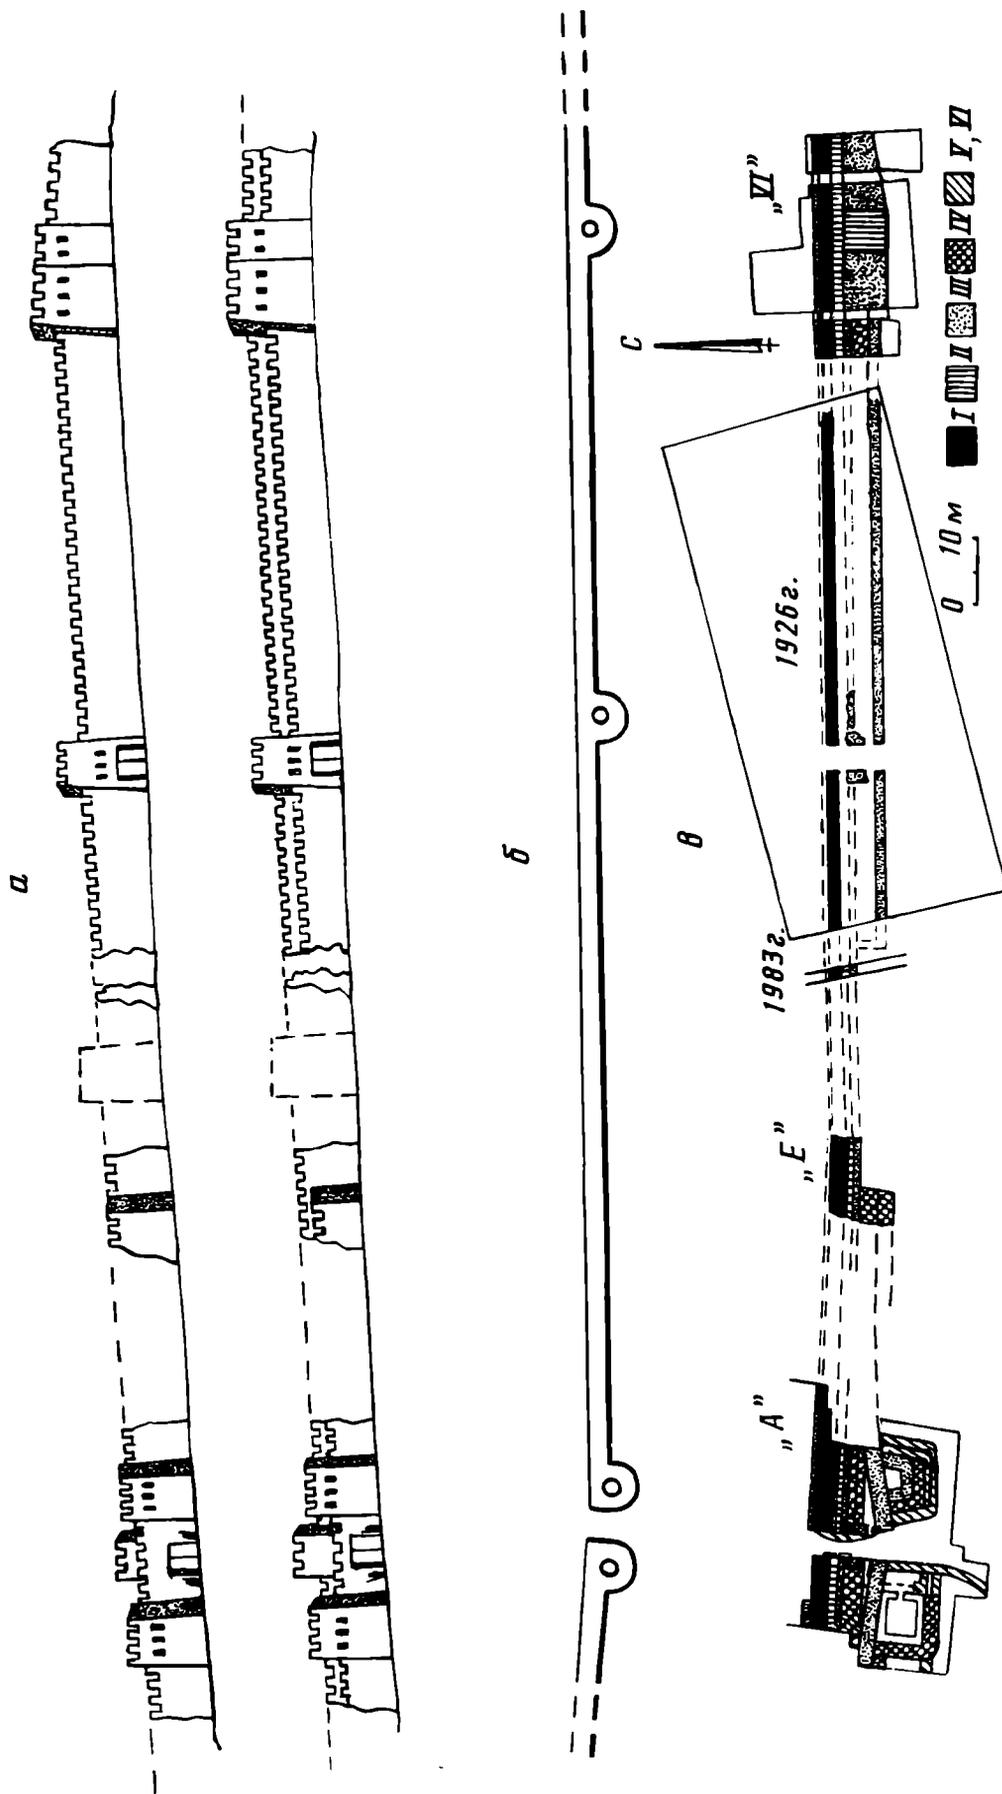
Реконструкция стены. а — объемная реконструкция южной стены четвертого строительного периода к востоку от главных ворот; б — план стены к востоку от главных ворот, по Ф. Дюбуа де Монпере; в — сводный план раскопов (I—VI — строительные периоды стены)
